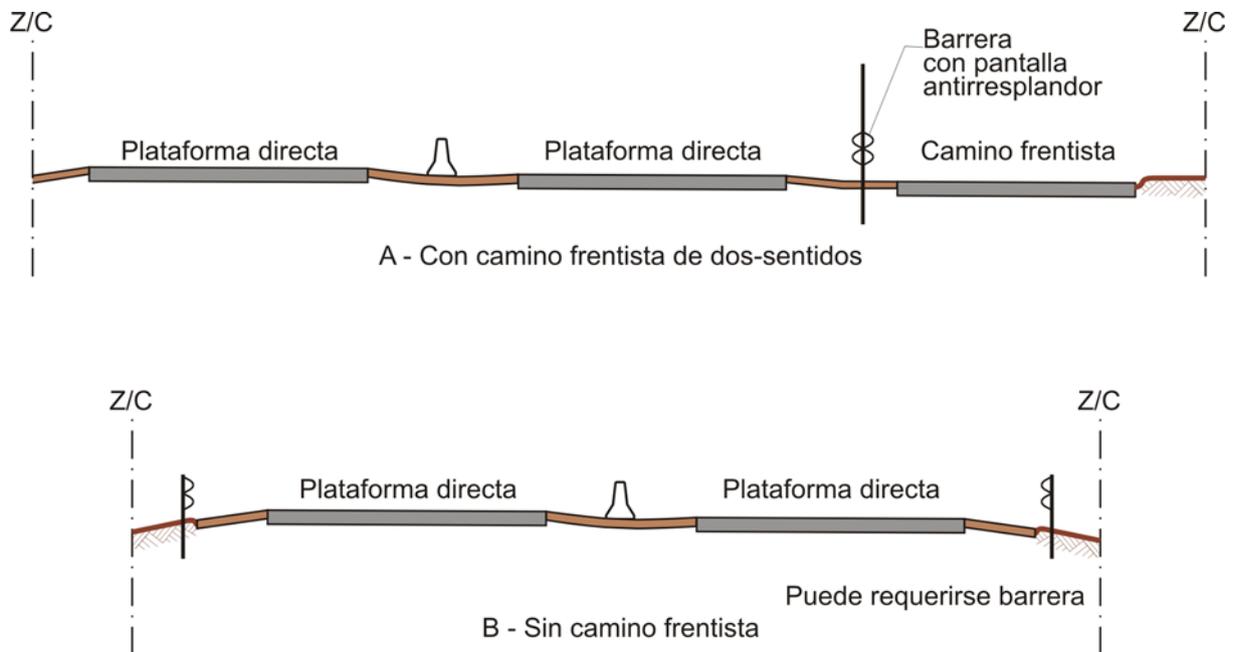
Secciones transversales restringidas para autopistas a nivel de terreno
